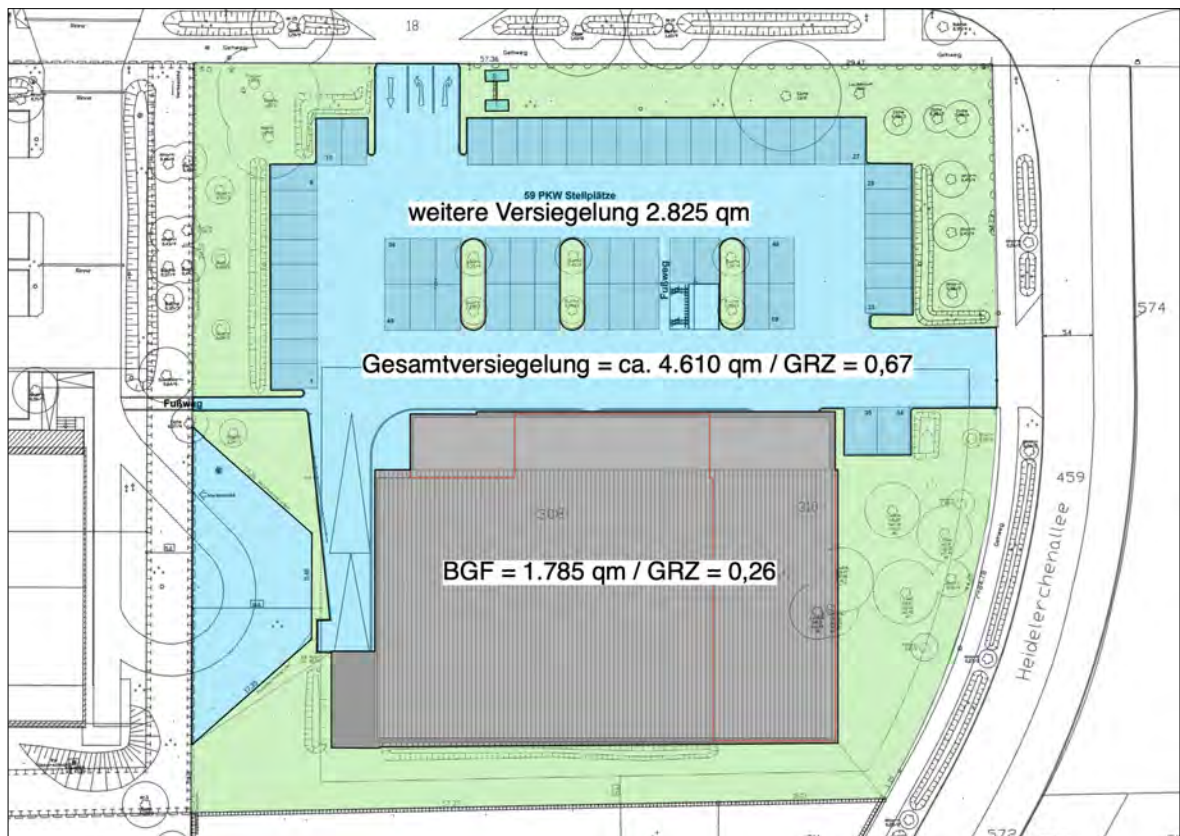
Lageplan Nahversorgungsmarkt (Quelle: Architekturbüro Krauter+Kling, Berlin)
